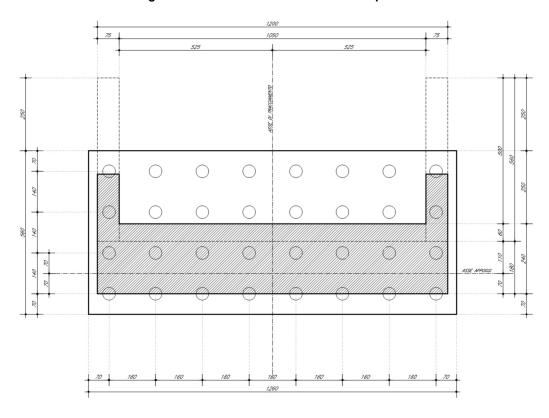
Pianta fondazione e spiccato elevazione spalla A
